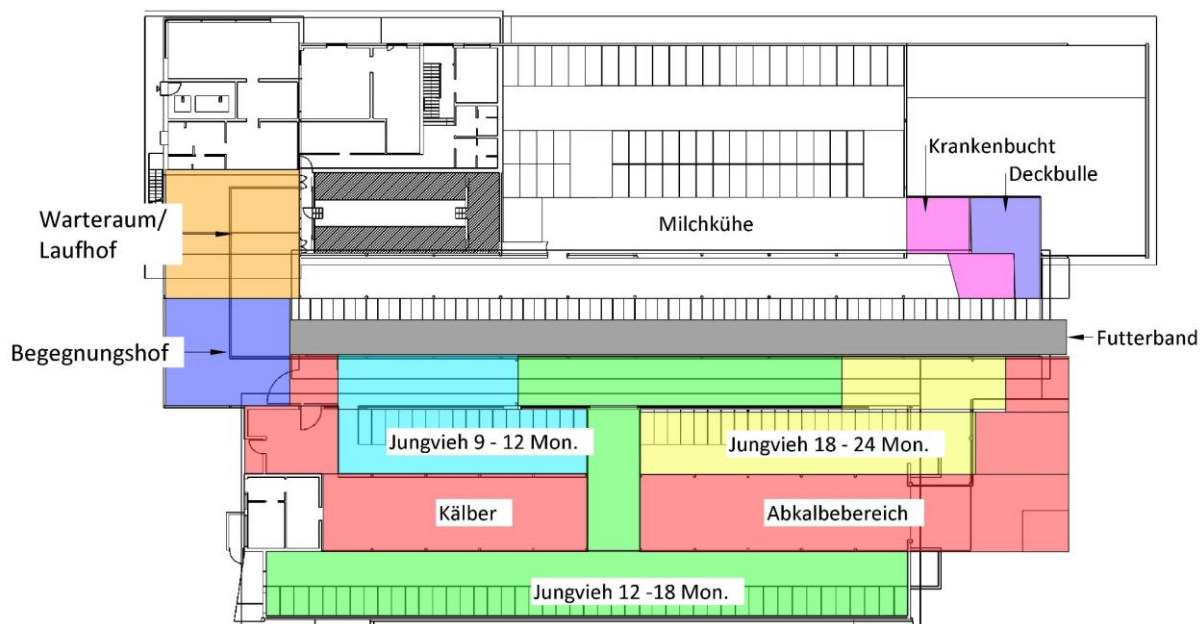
Einteilung des Stalles nach dem geplanten Umbau
